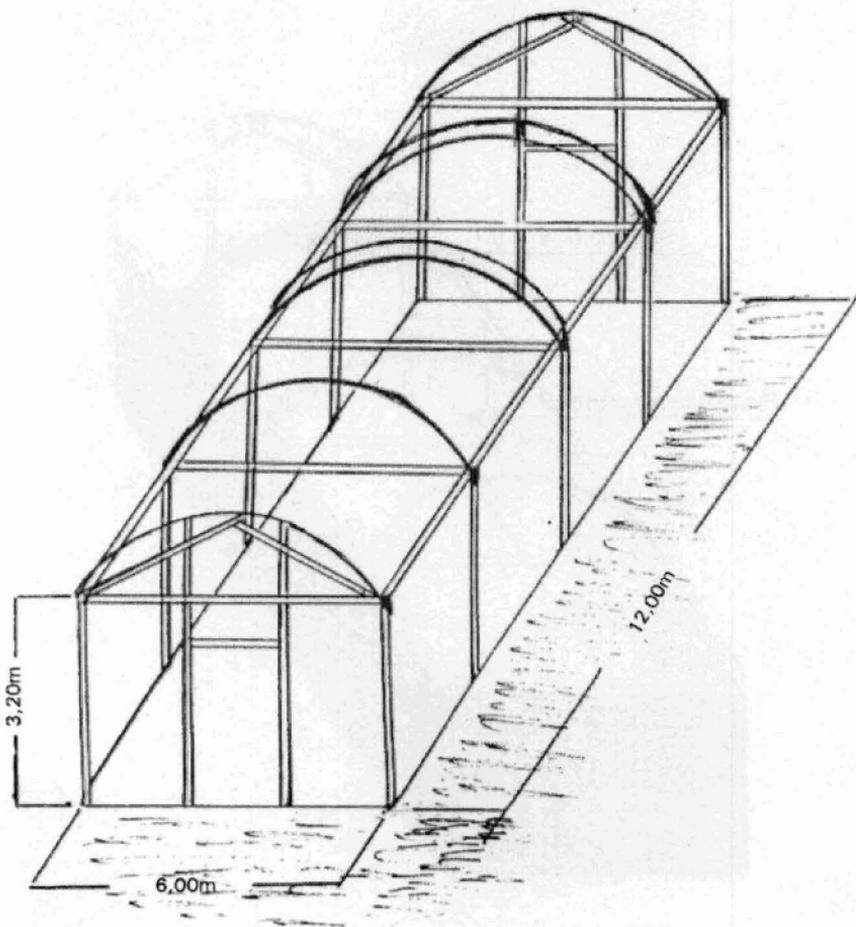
Estrutura do telado, tipo tunel alto, com madeiramento e arcos.
